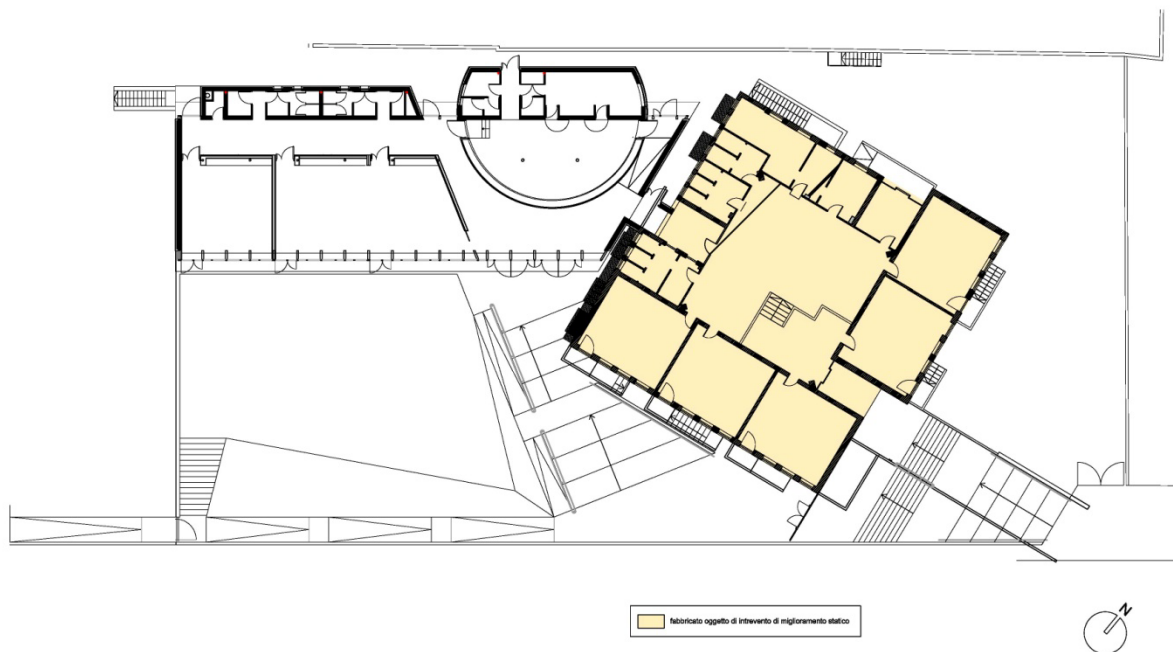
Planimetria generale con indicazione del fabbricato oggetto di intervento.
